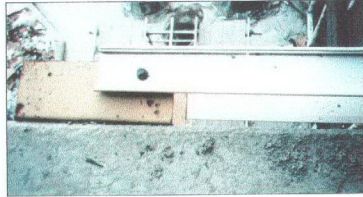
Zincirlikuyu Towers binalarında kullanılan hafif giydirme cephe sistemi
